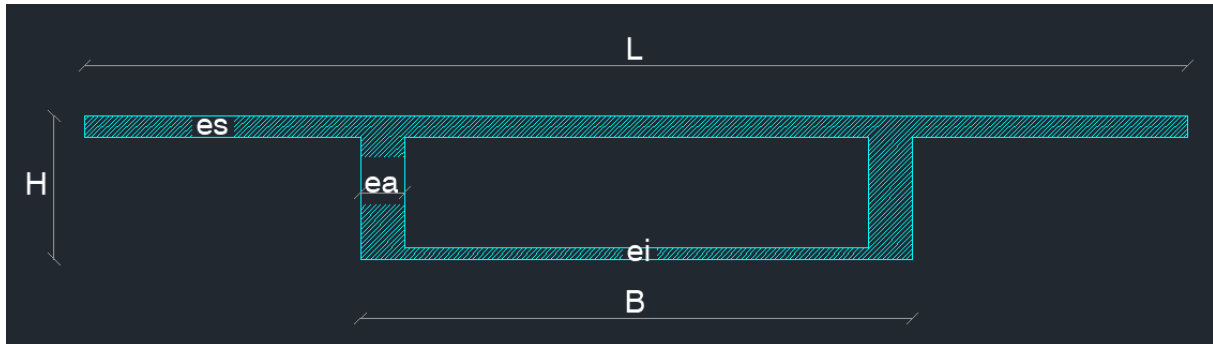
Schéma présente la section d'un tablier en caisson.
